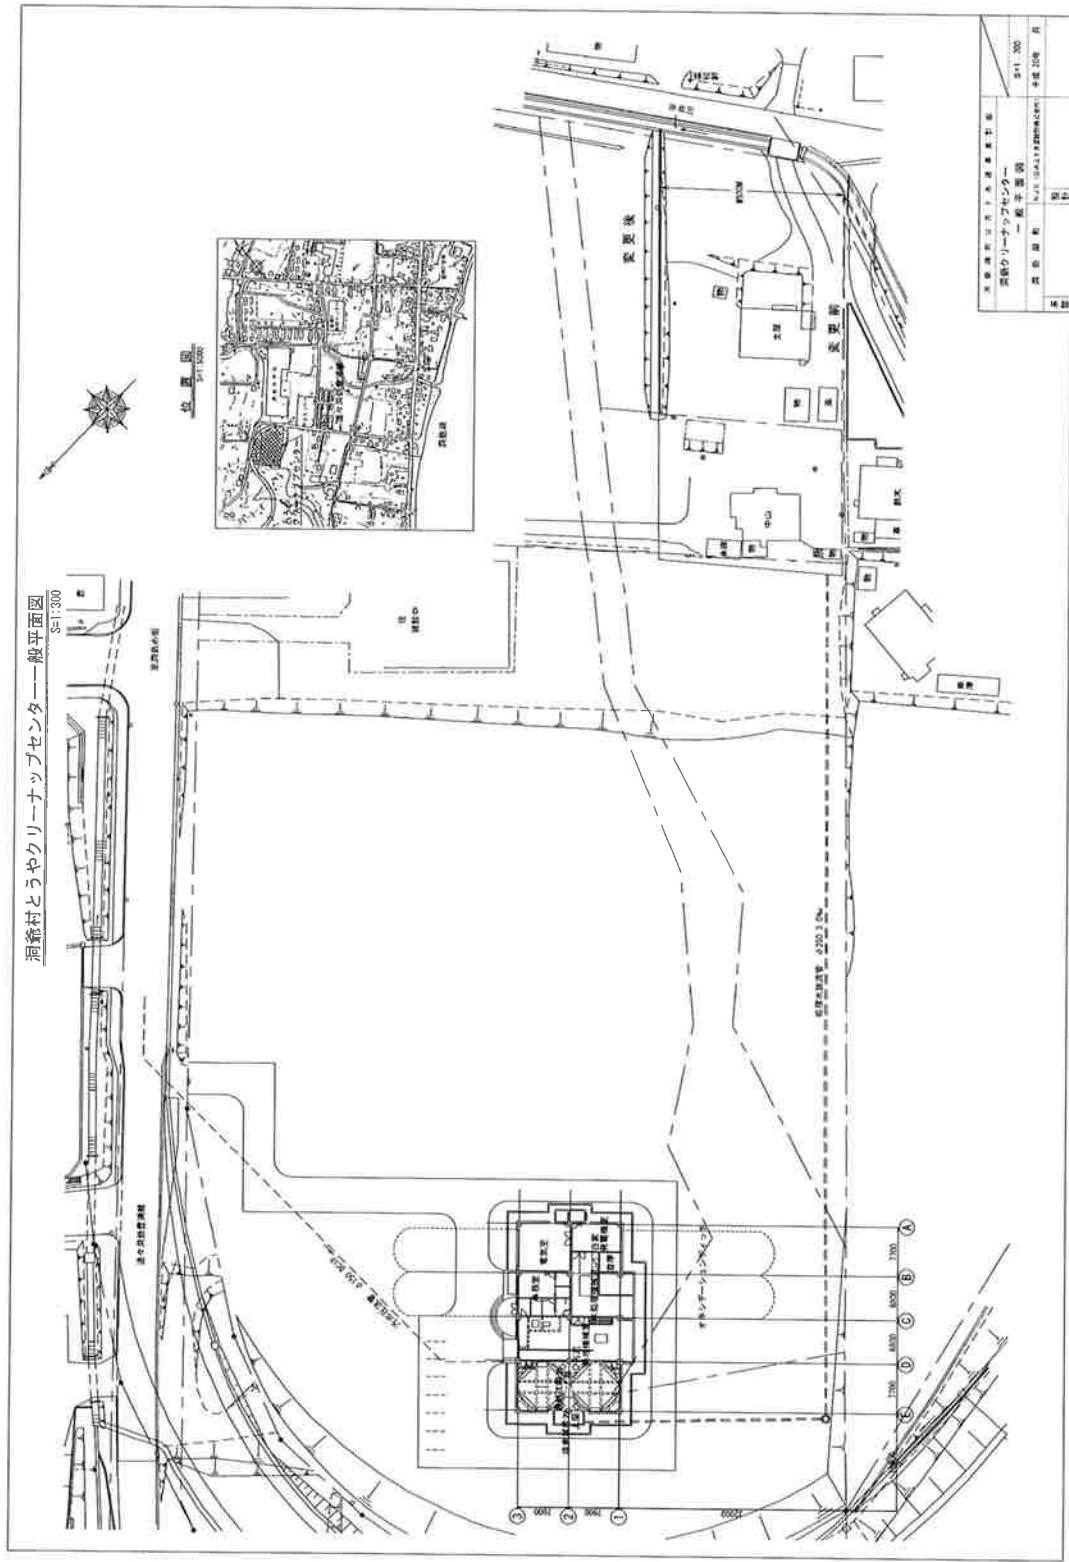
どうやクリーナップセンター 一般平面図 (Non-scale)
